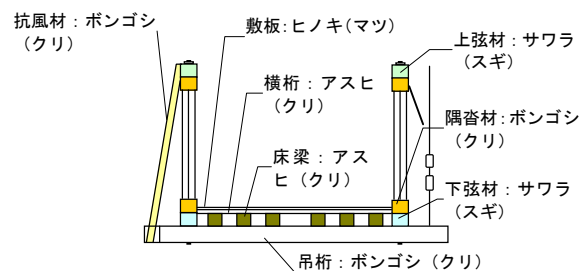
補剛桁断面図 (カッコ内は原設計時の使用材)
